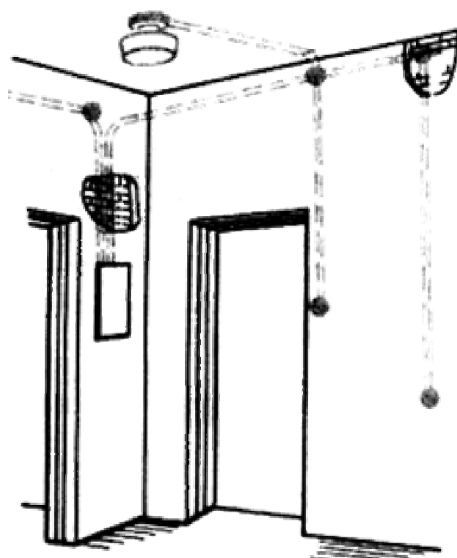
Скрытые электропроводки под слоем мокрой штукатурки
